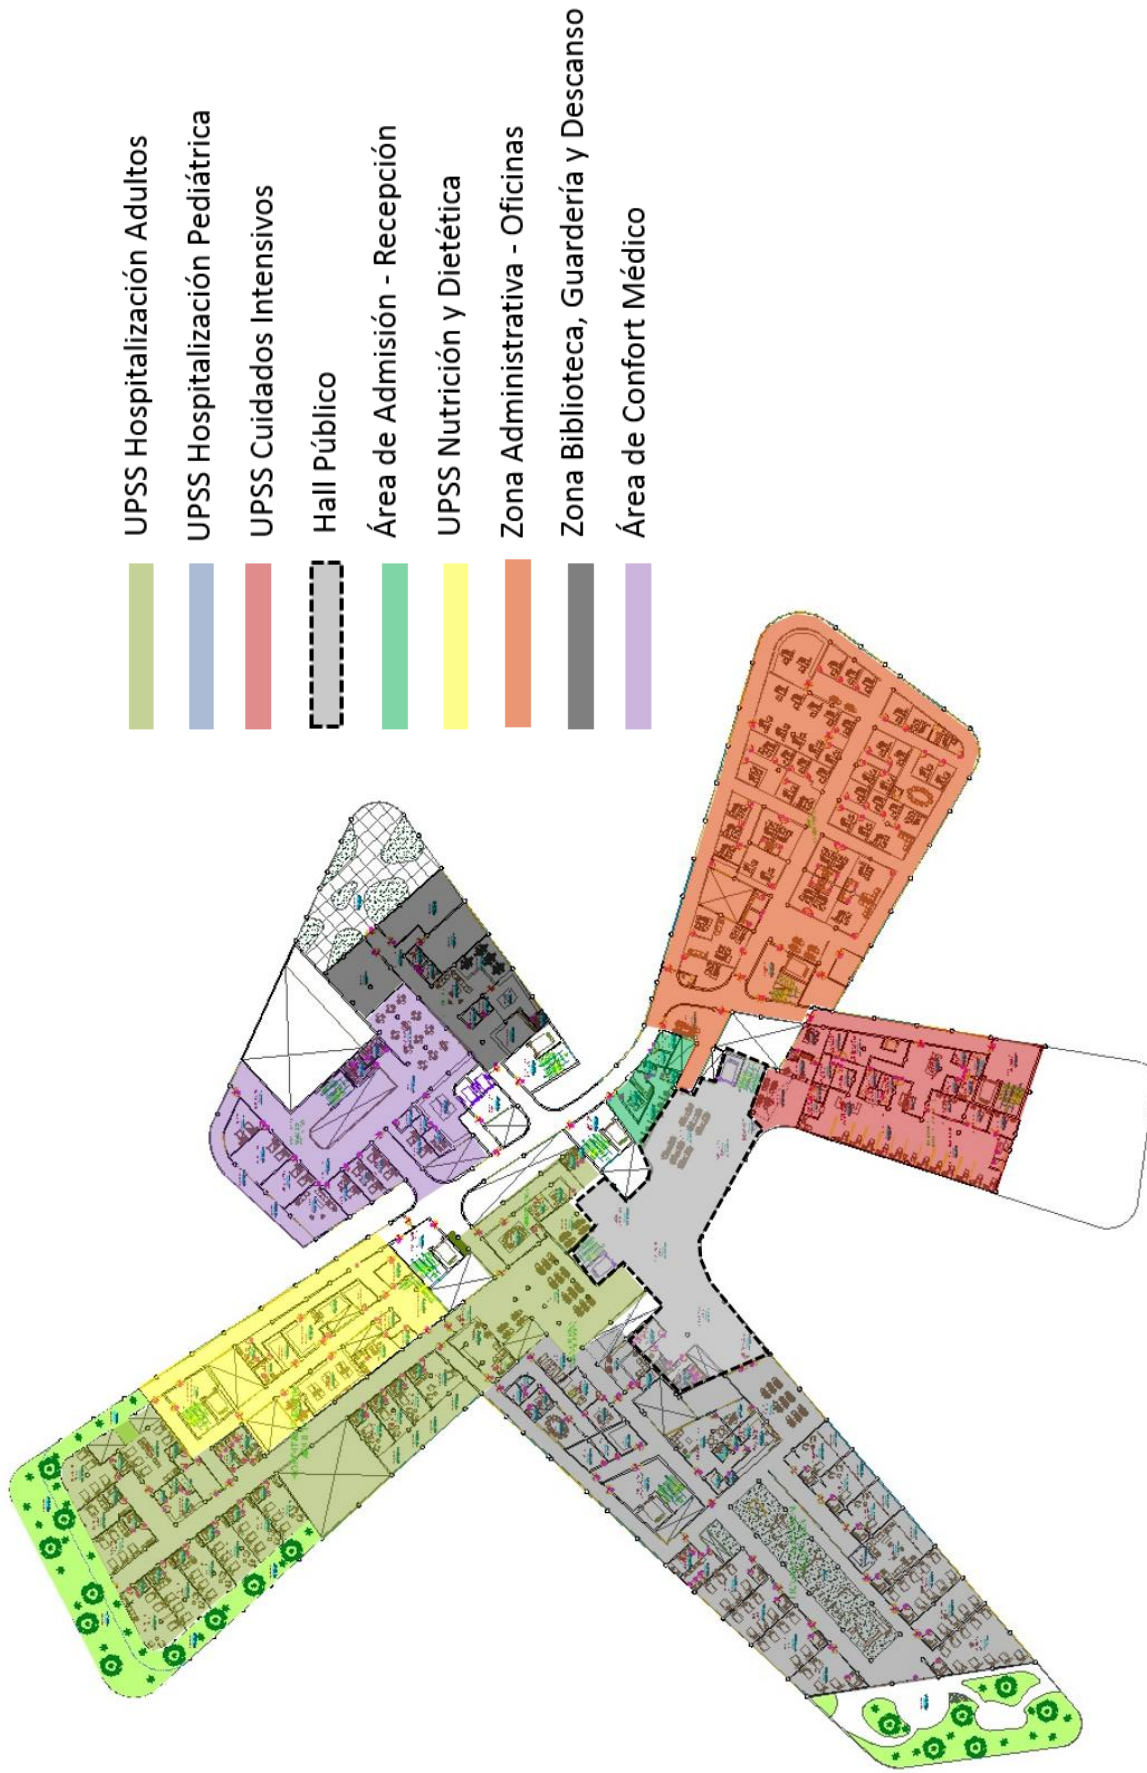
Zonificación Tercera Planta de la Propuesta Arquitectónica.
